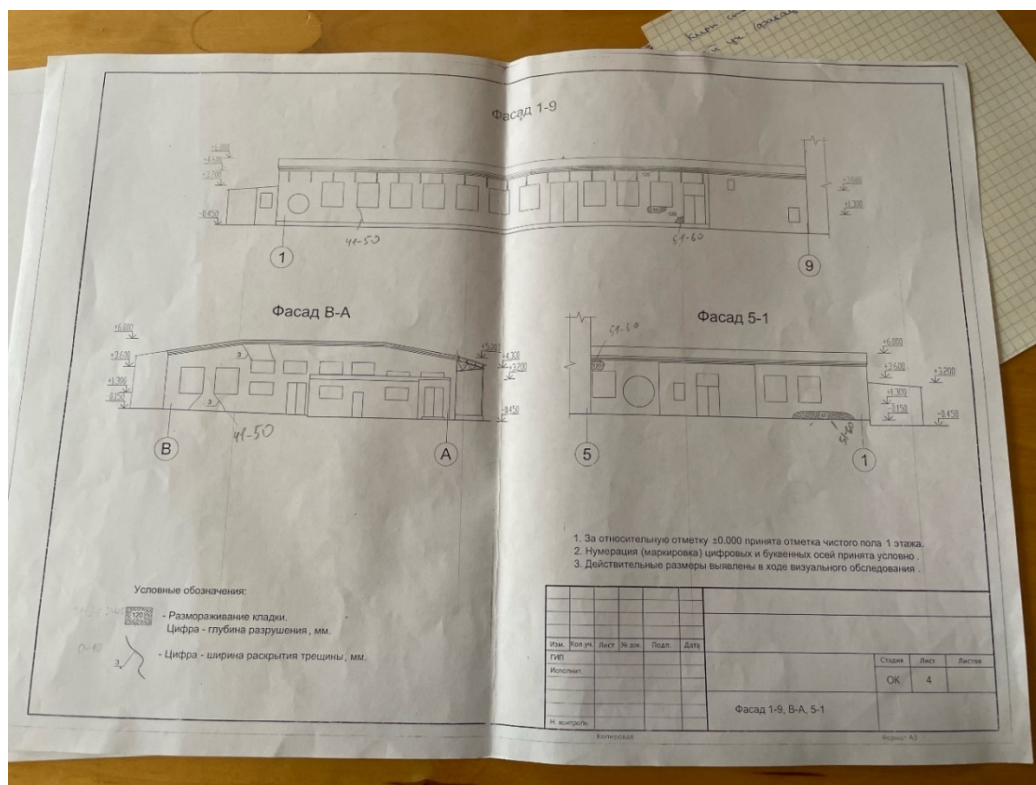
Фасады 1-9, В-А и 5-1 жилого дома по адресу г. Киров, ул. Грибоедова, д. 30 с повреждениями (дефектами) (авторская разработка)
